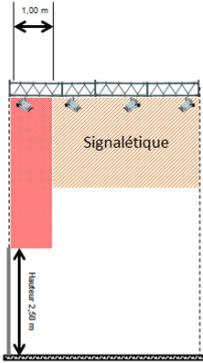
HAUTEUR DE CONSTRUCTIONS / RETRAITS
